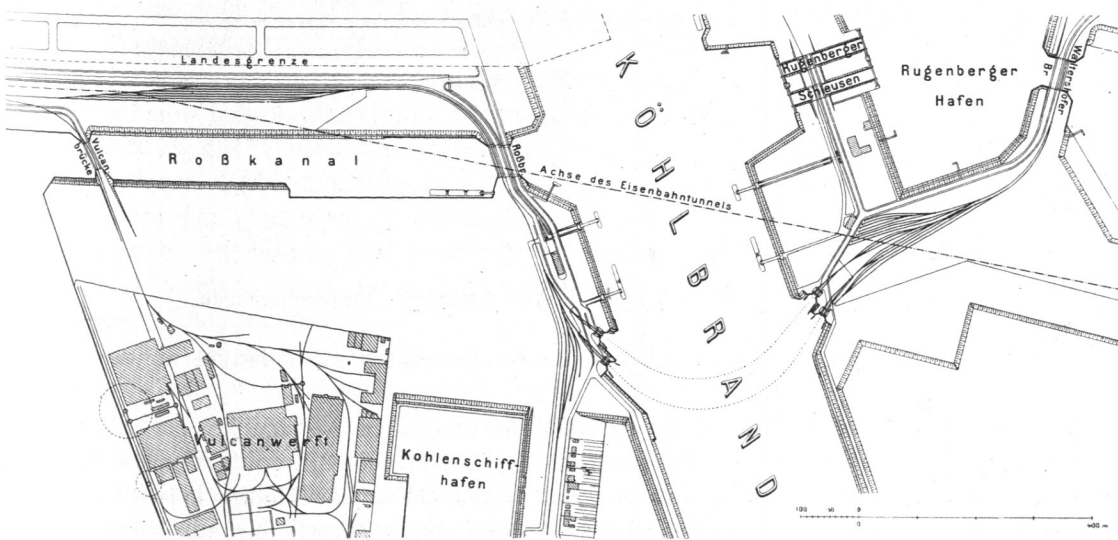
Eisenbahnfähre über den Köhlbrand, Lageplan.
